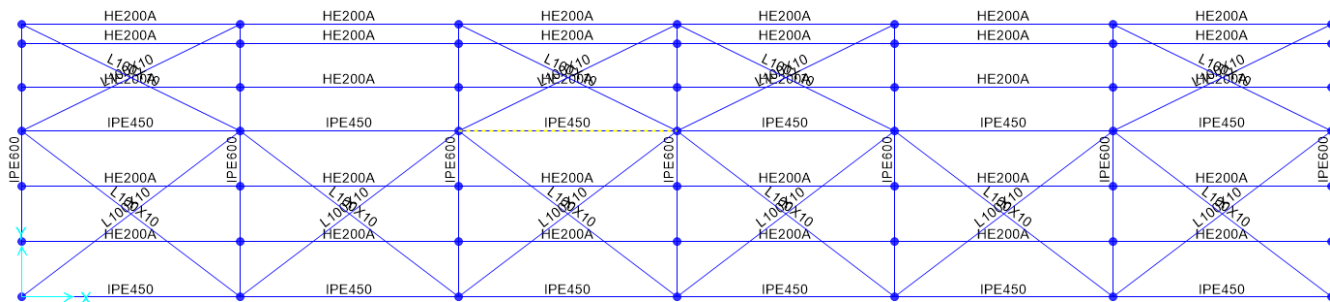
Vista della copertura con indicazione delle sezioni delle travi
